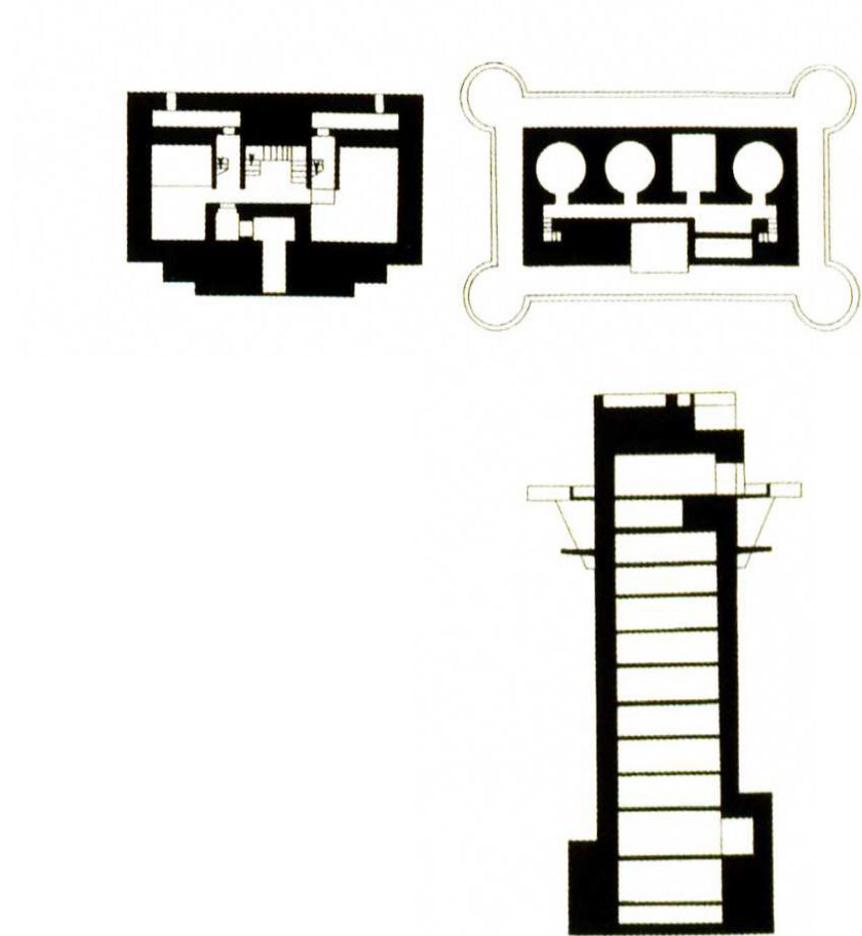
Pianta piano terra, pianta ultimo piano e sezione della torre LVII.
